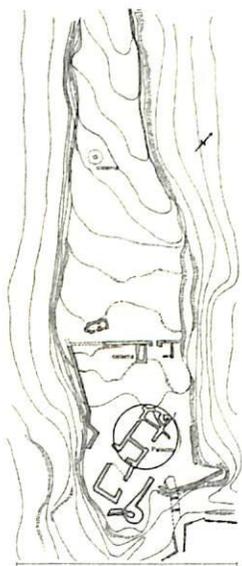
Gerace (RC). Planimetria del castello. Il cerchio individua il palazzo.
